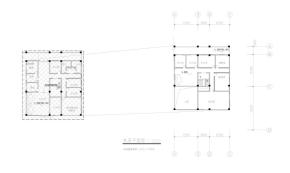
夹层平面图(图片来源: 作者自绘) Fig. 5 Mezzanine floor plan
